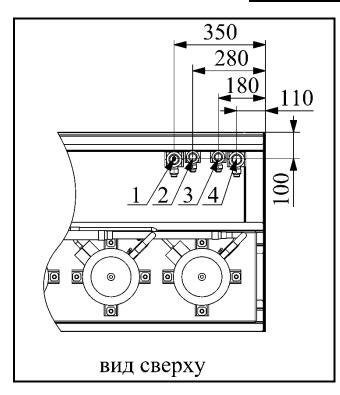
Схема крепления виброизоляторов к чиллеру (вид сверху).
